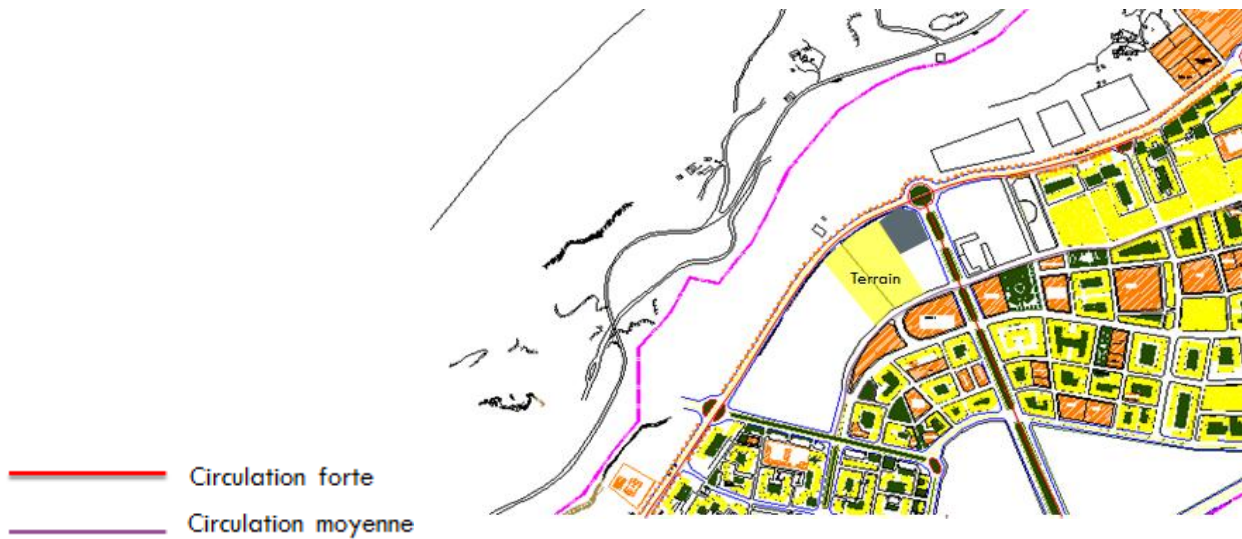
Plan de masse du site 1 –quartier Akid Lotfi
